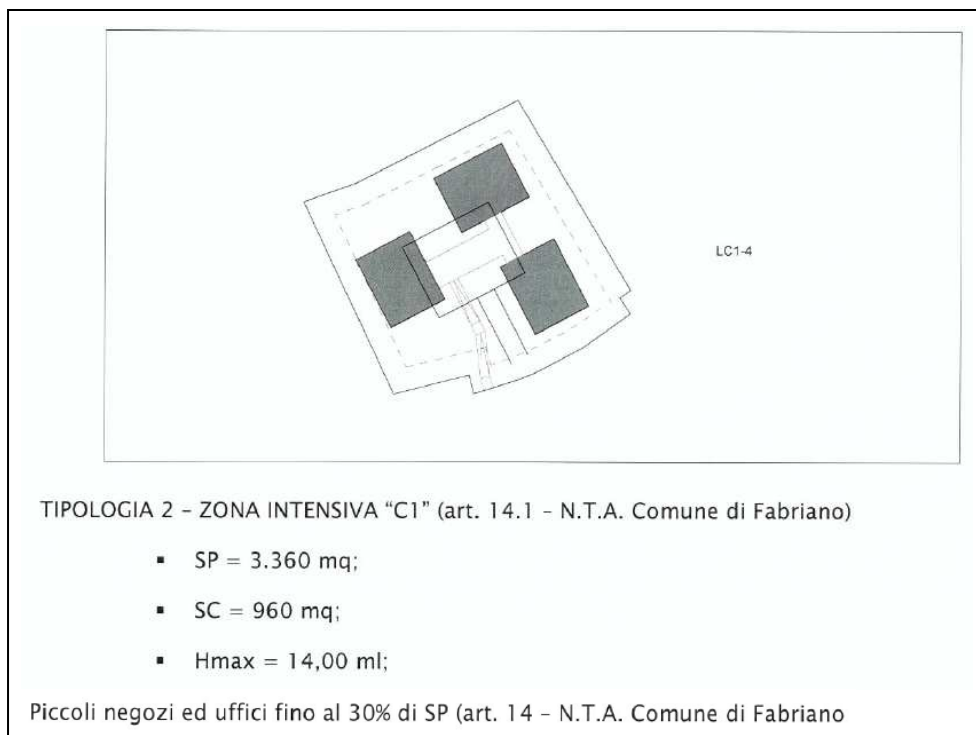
Estratto dalle N.T.A. in Variante al P.d.L. (Allegato 3)
